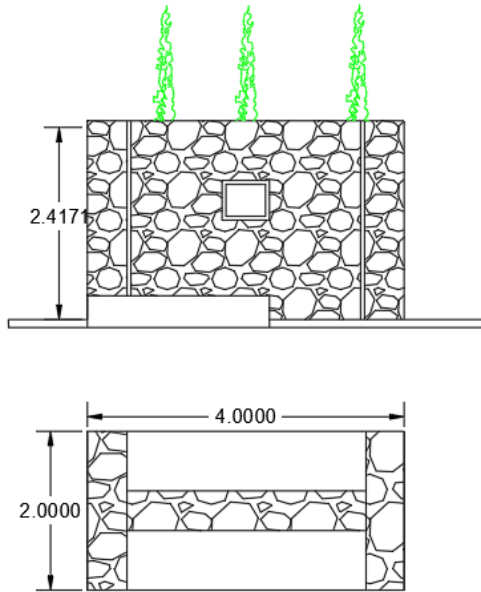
Capilla de mampostería corte y fachada (autoría propia )
